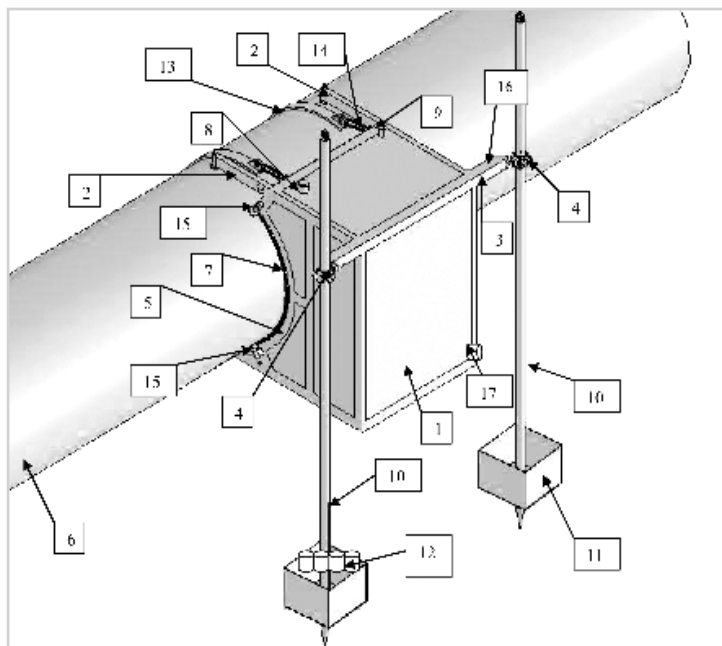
Общий вид специализированного подводного кессона Захарова: корпус — 1; направляющие — 2; крепежный кронштейн — 3; шарнирное устройство — 4; сегментный вырез корпуса — 5; магистральный трубопровод — 6; резиновый уплотнитель — 7; вентиляционные отверстия — 8, 9; штанги-груза — 10; балластные ящики — 11; балластные груза — 12; прижимные полукольца — 13; талрепы — 14; болты-упоры — 15; монтажные петли — 16; выходной штуцер — 17
